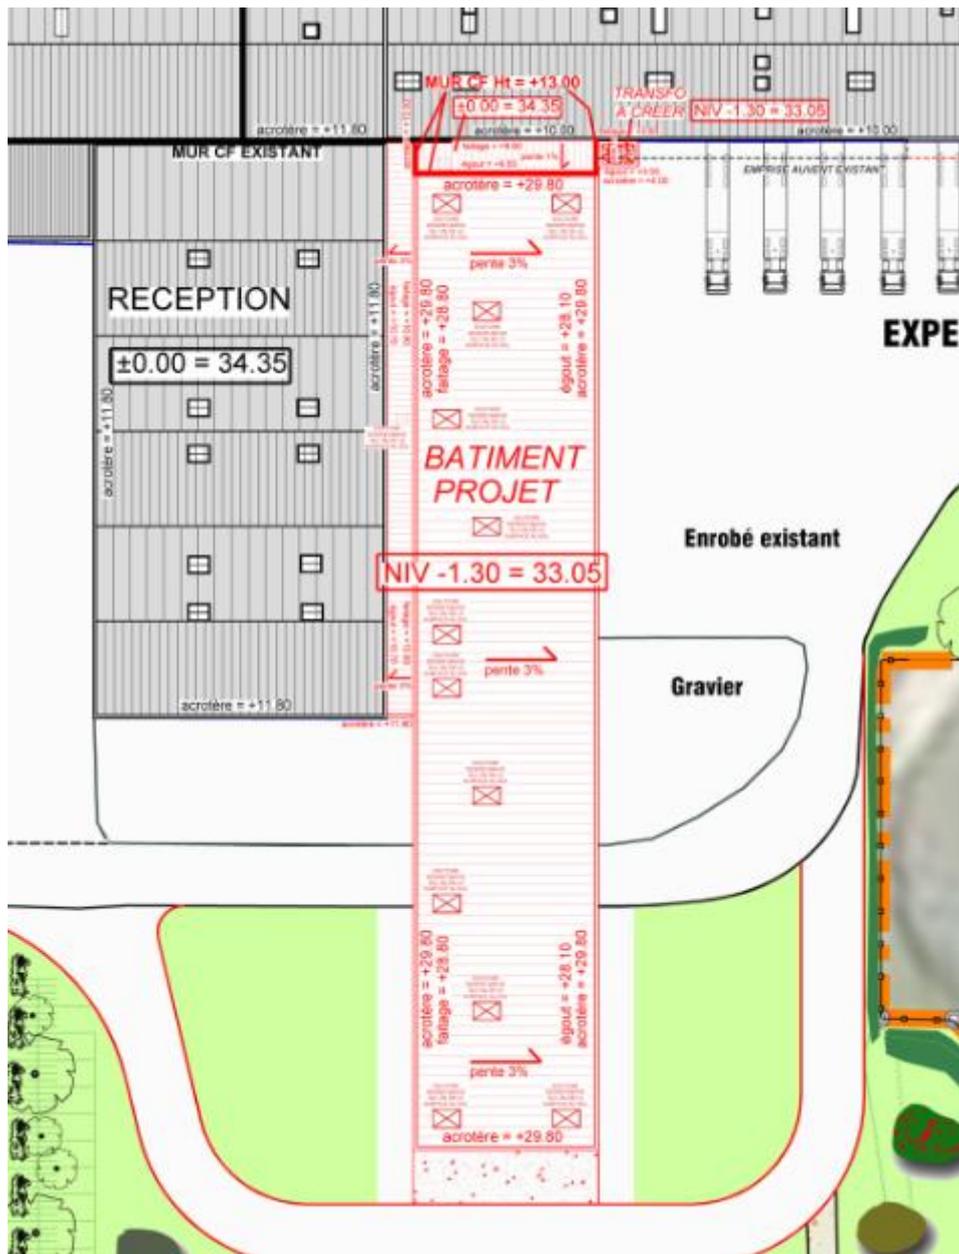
Zoom sur le plan masse du projet (Source : CAN)
